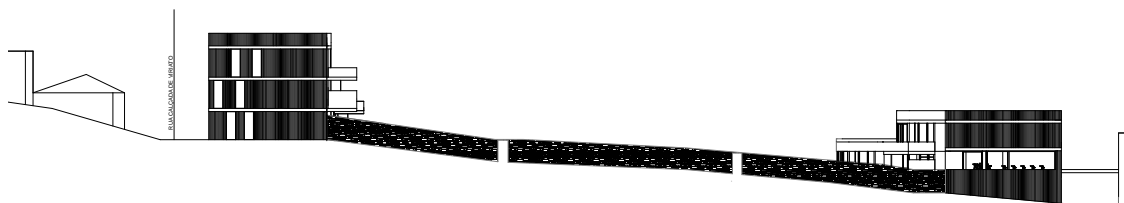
Alçado da Rua Dr. Silva Gaio.
